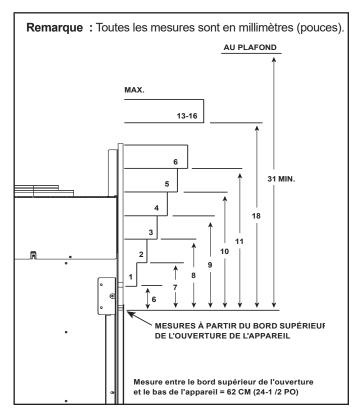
Dimensions des matériaux non combustibles minimaux verticaux et maximaux horizontaux - Ensemble de chaleur passive installé (toutes les tailles)
